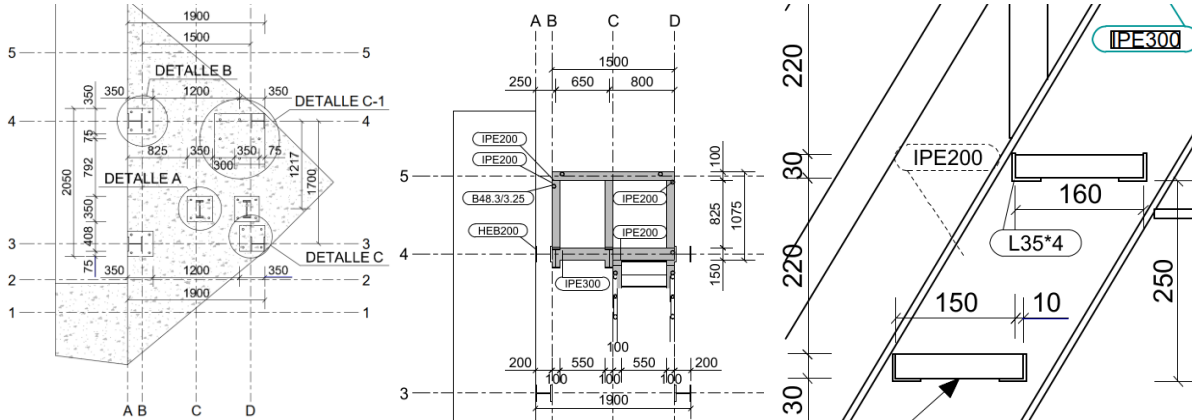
Planta de cimentación y descansillo, así como detalle de zancas
